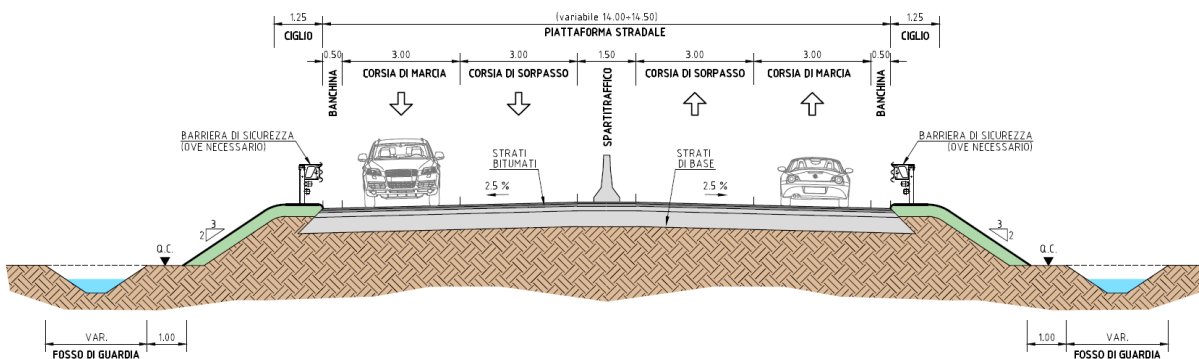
Sezione tipo in rilevato – Viabilità esistente SS16
